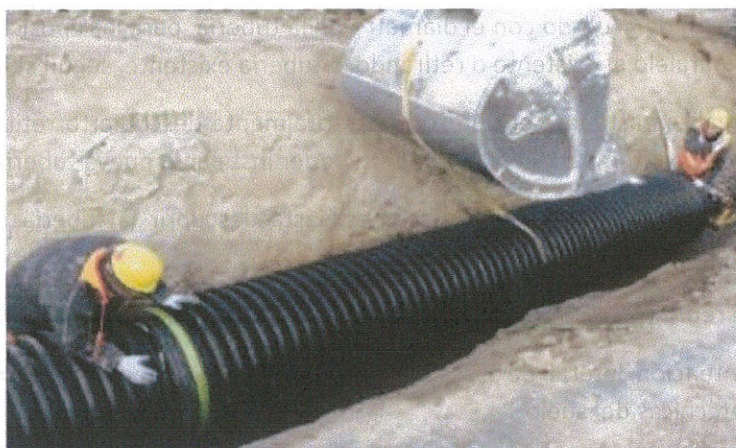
Instalación de tubería para alcantarillado. (Fuente: SIAPA)
